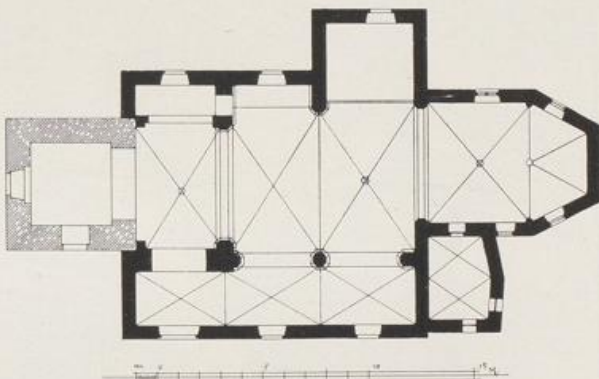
Gladbach. Grundriss der kathol. Pfarrkirche.
